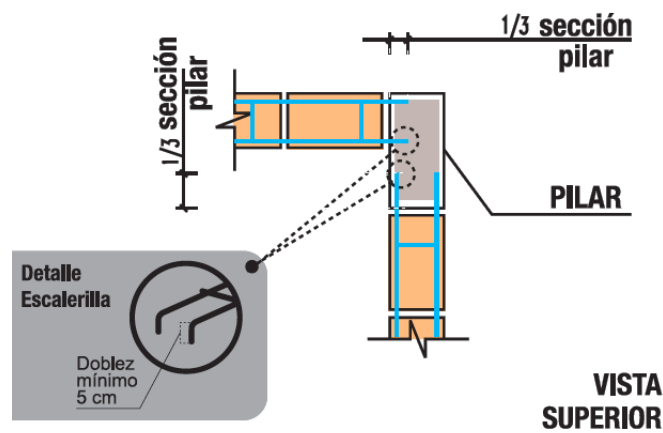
Unión paño-pilar con escalerillas (ACMA, 2011)
